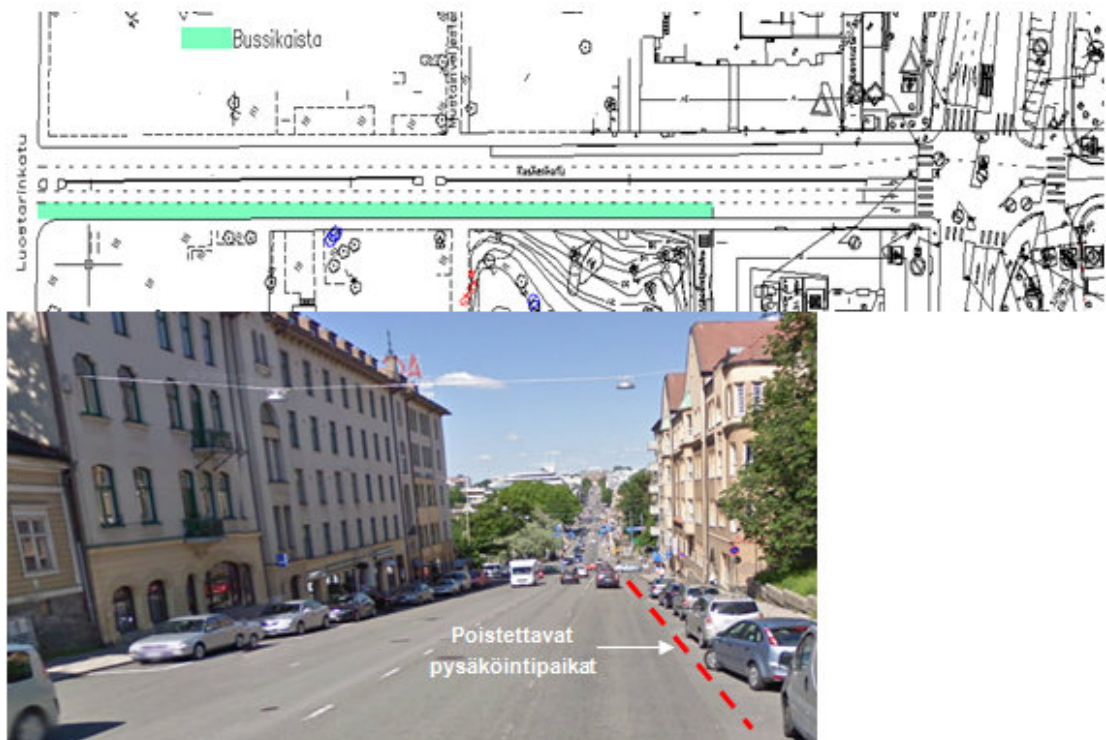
Rakenteelliset toimenpiteet joukkoliikenteen sujuvoittamiseksi Turussa.
